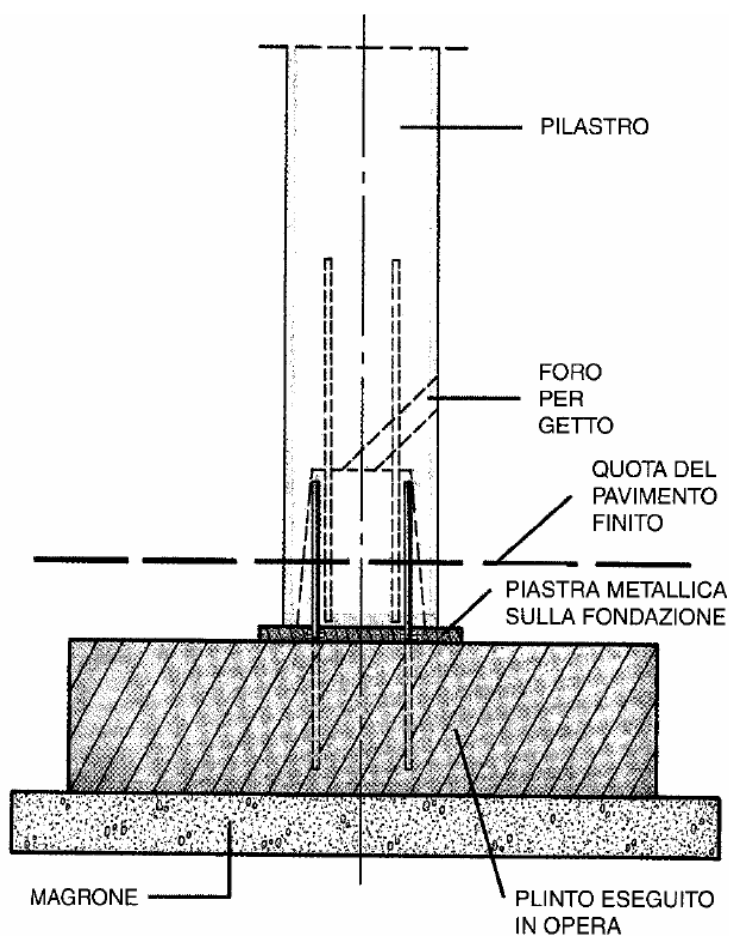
Schema di un collegamento con flange bullonate tra pilastro e fondazione in calcestruzzo.
